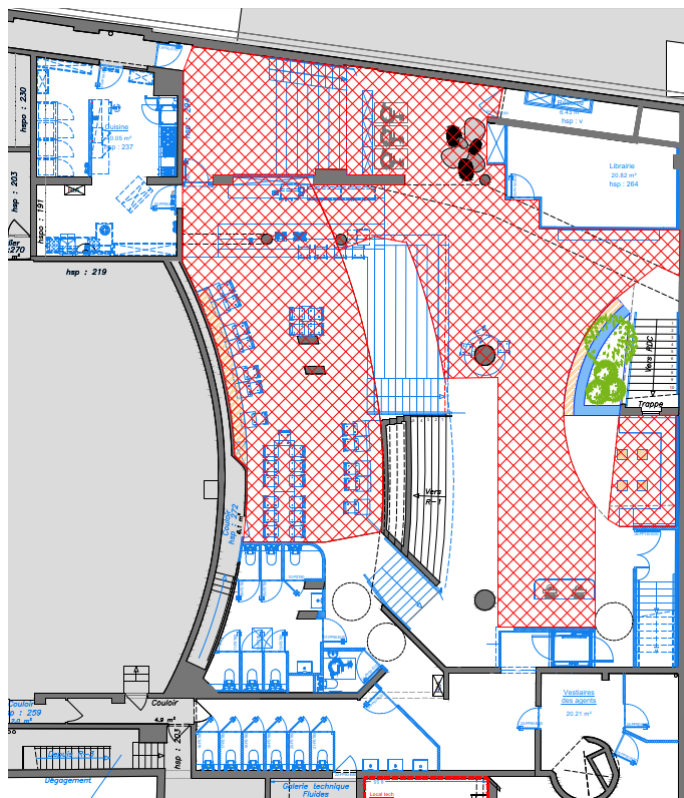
Plan du niveau R-2 – Surface couverte par le système SPK
